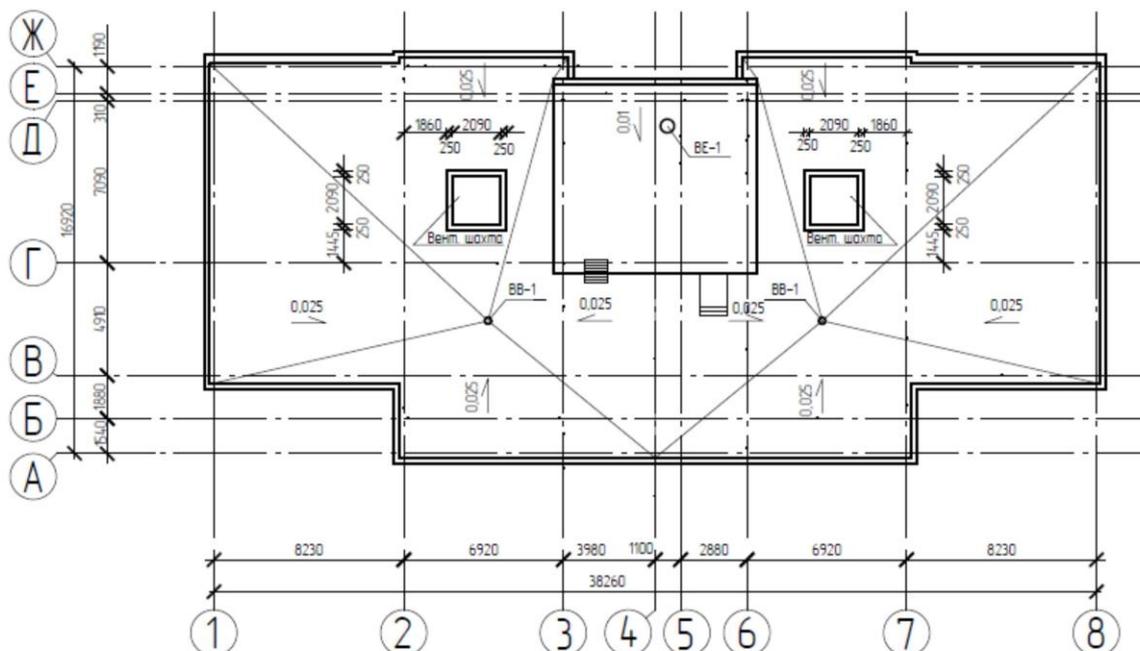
Пример плана кровли здания с внутренним водостоком
